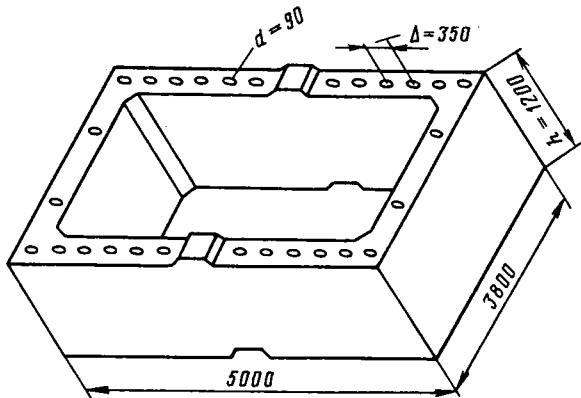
Крупногабаритный коробчатый блок «Давидашен»
